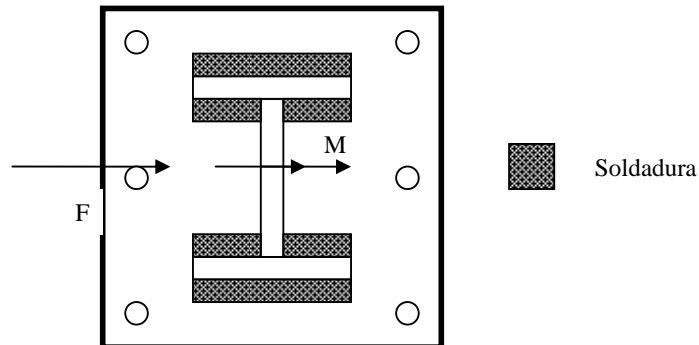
Diagrama de soldadura de la placa de anclaje.
